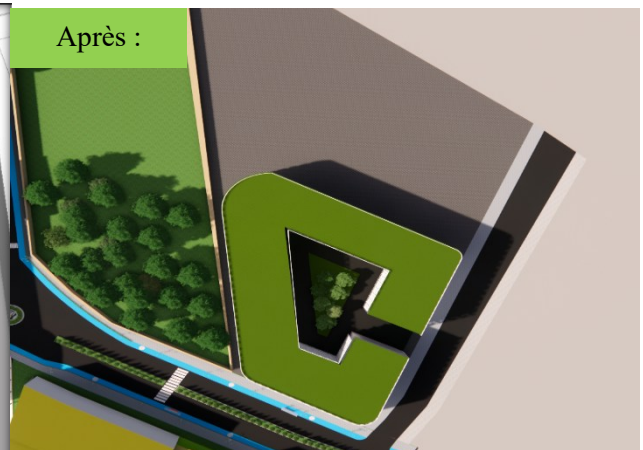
vue en plan de l'immeuble parking après l'intervention.
